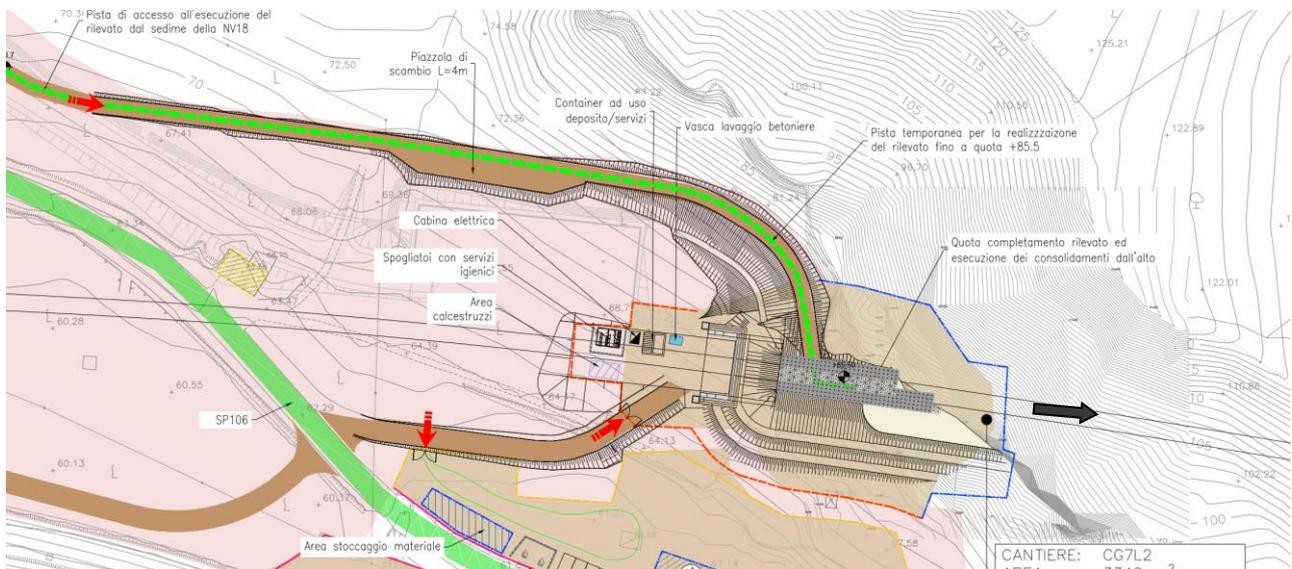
Planimetria di completamento del rilevato ed esecuzione consolidamenti
